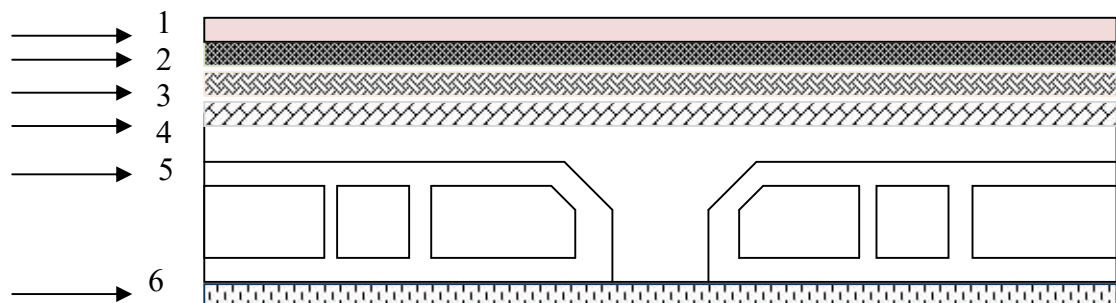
détail des constituants du plancher terrasse inaccessible.
